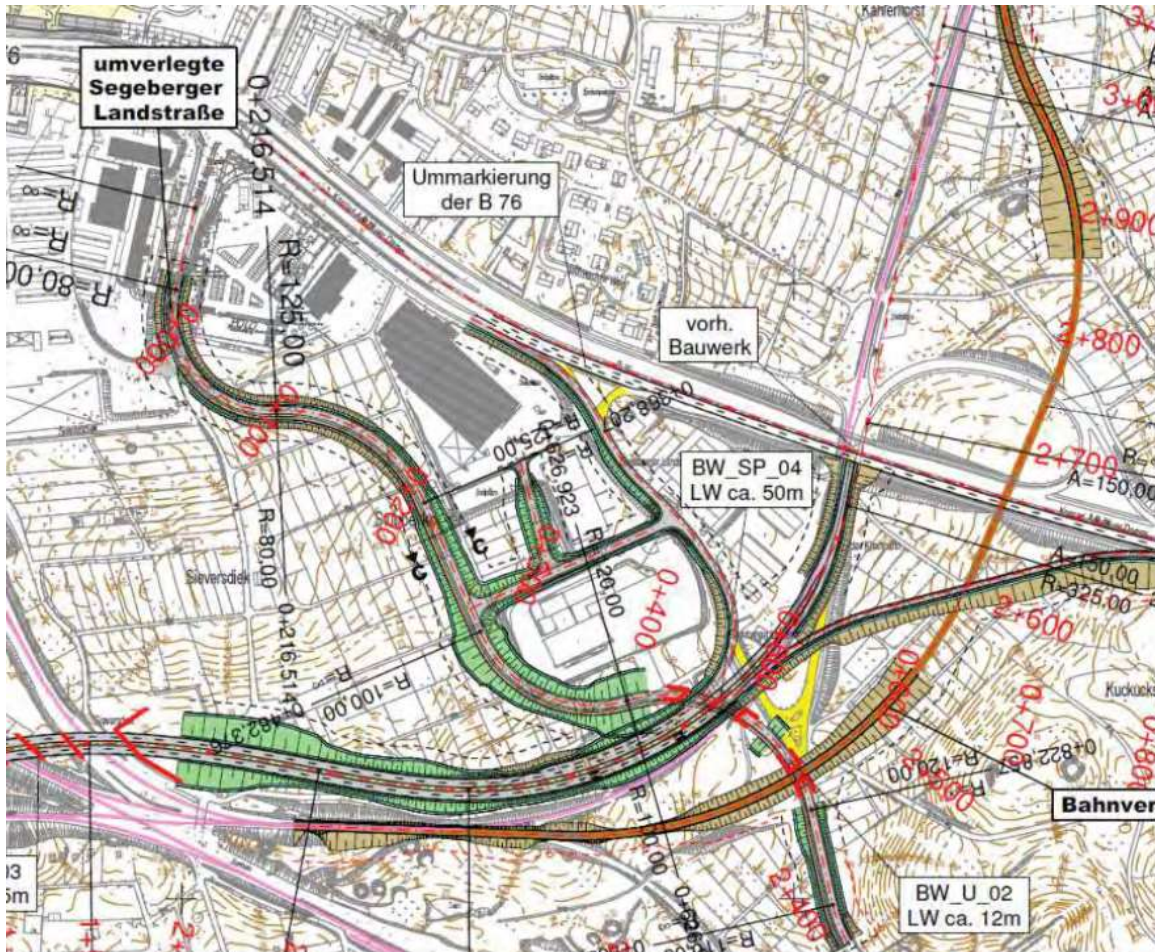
Anschluss B 76 Planfall 1 (S. 91) (Umverlegung Bad Segeberger Landstraße)
